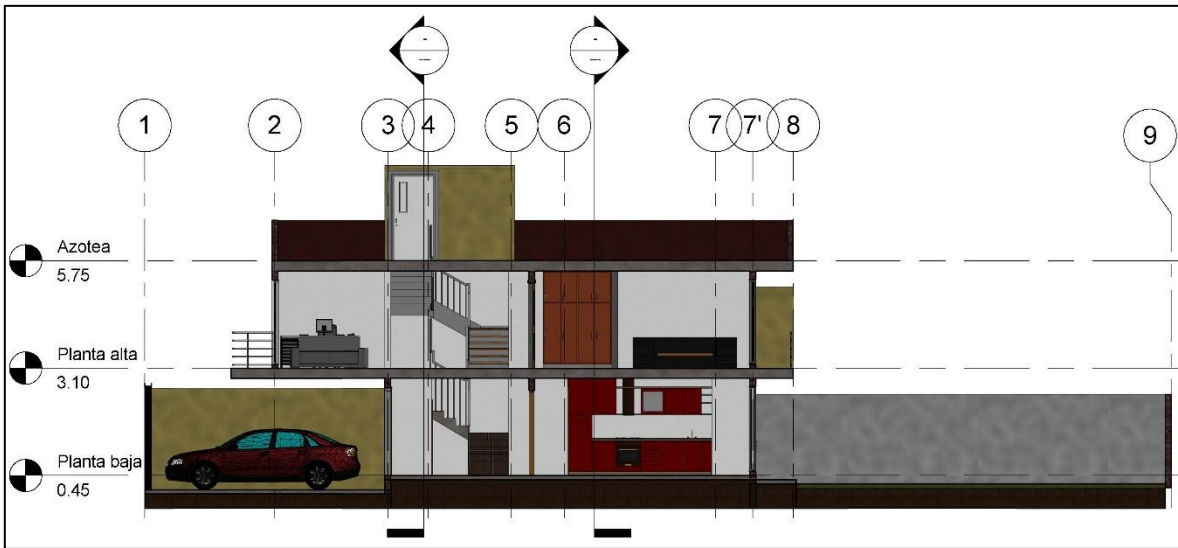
Plano de proyecto no sustentable: sección longitudinal 02. Fuente: autoría propia
